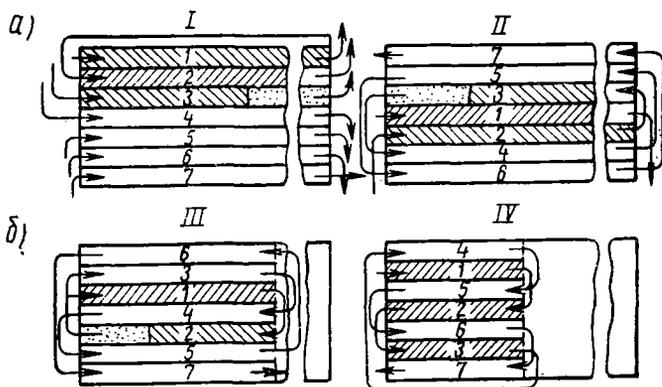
Схемы устройства полос аэродромных покрытий: I — бетонирование от обочины без маячных рядов; II — бетонирование от середины без маячных рядов; III — бетонирование с двумя маячными рядами; IV — бетонирование с тремя маячными рядами;
